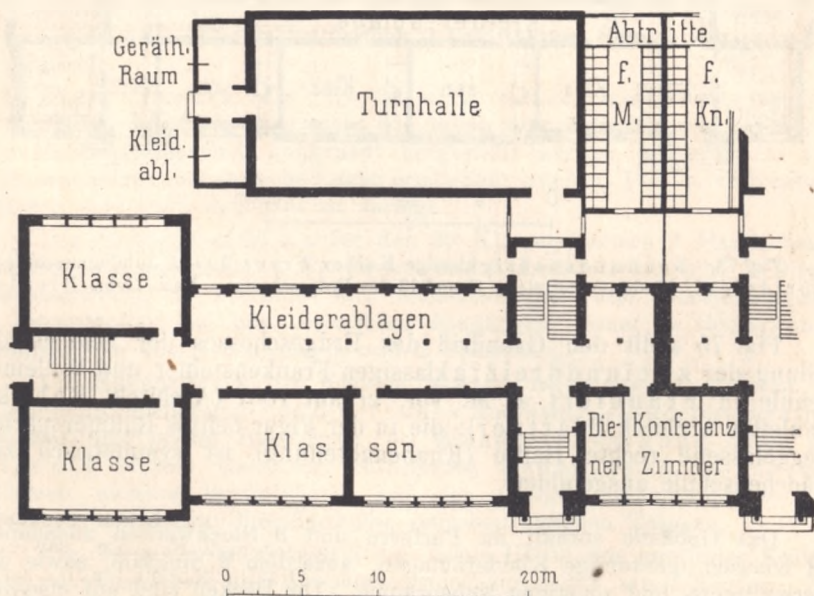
Zweiunddreißigklassige Schule in Frankfurt a. M. Grundriß des Erdgeschosses. Aus Blattner⁸⁹.
